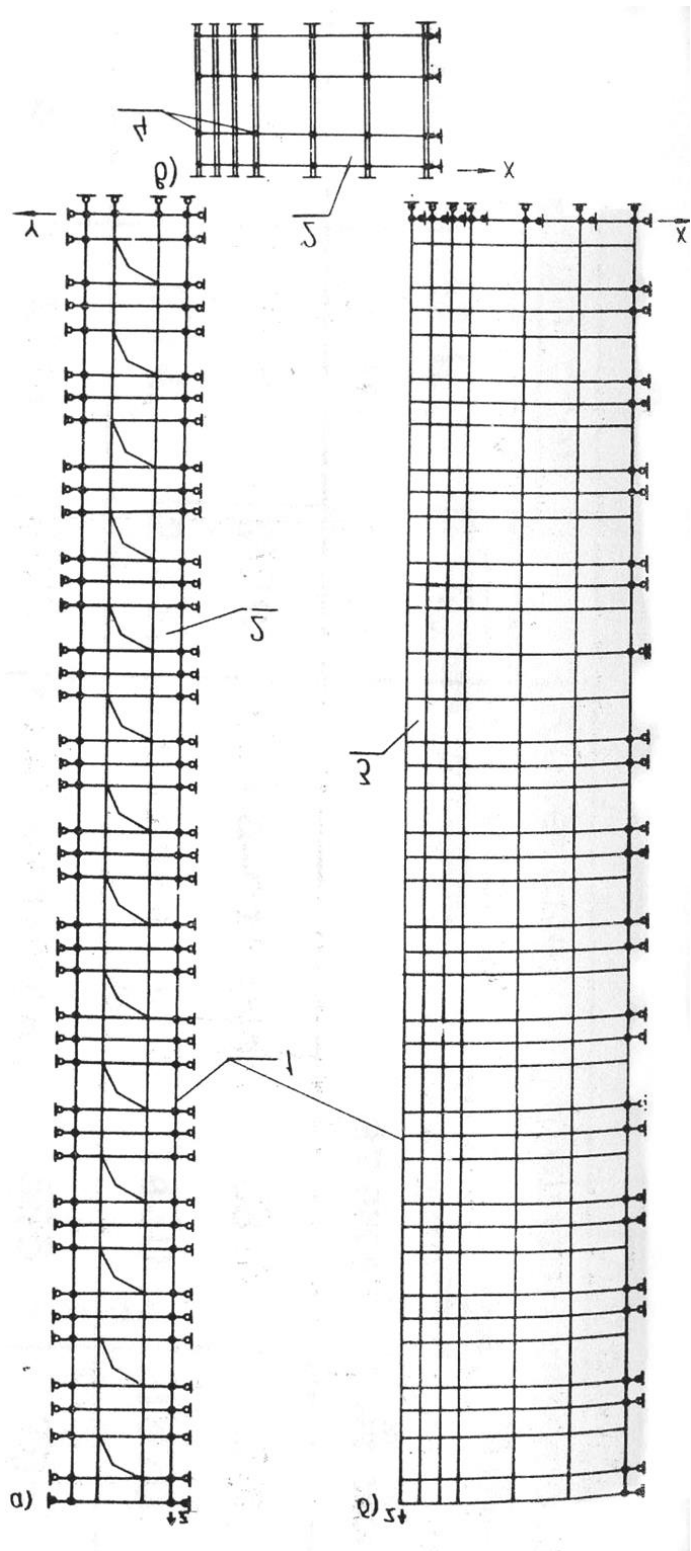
Расчётная схема 14 – этажного фрагмента
